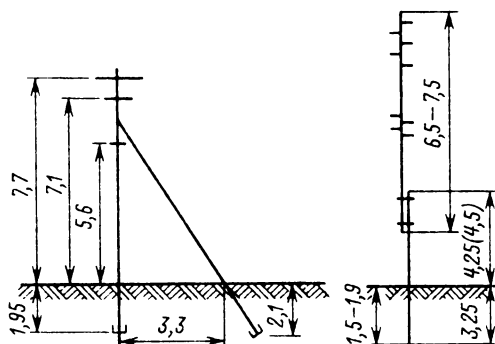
Железобетонная анкерная угловая одноцепная опора ВЛ 380 В
